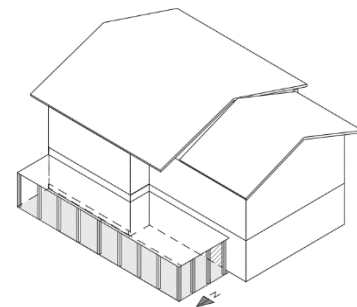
Esquema de configuración de modelado de la galería acristalada. Fuente: Elaboración Propia.
